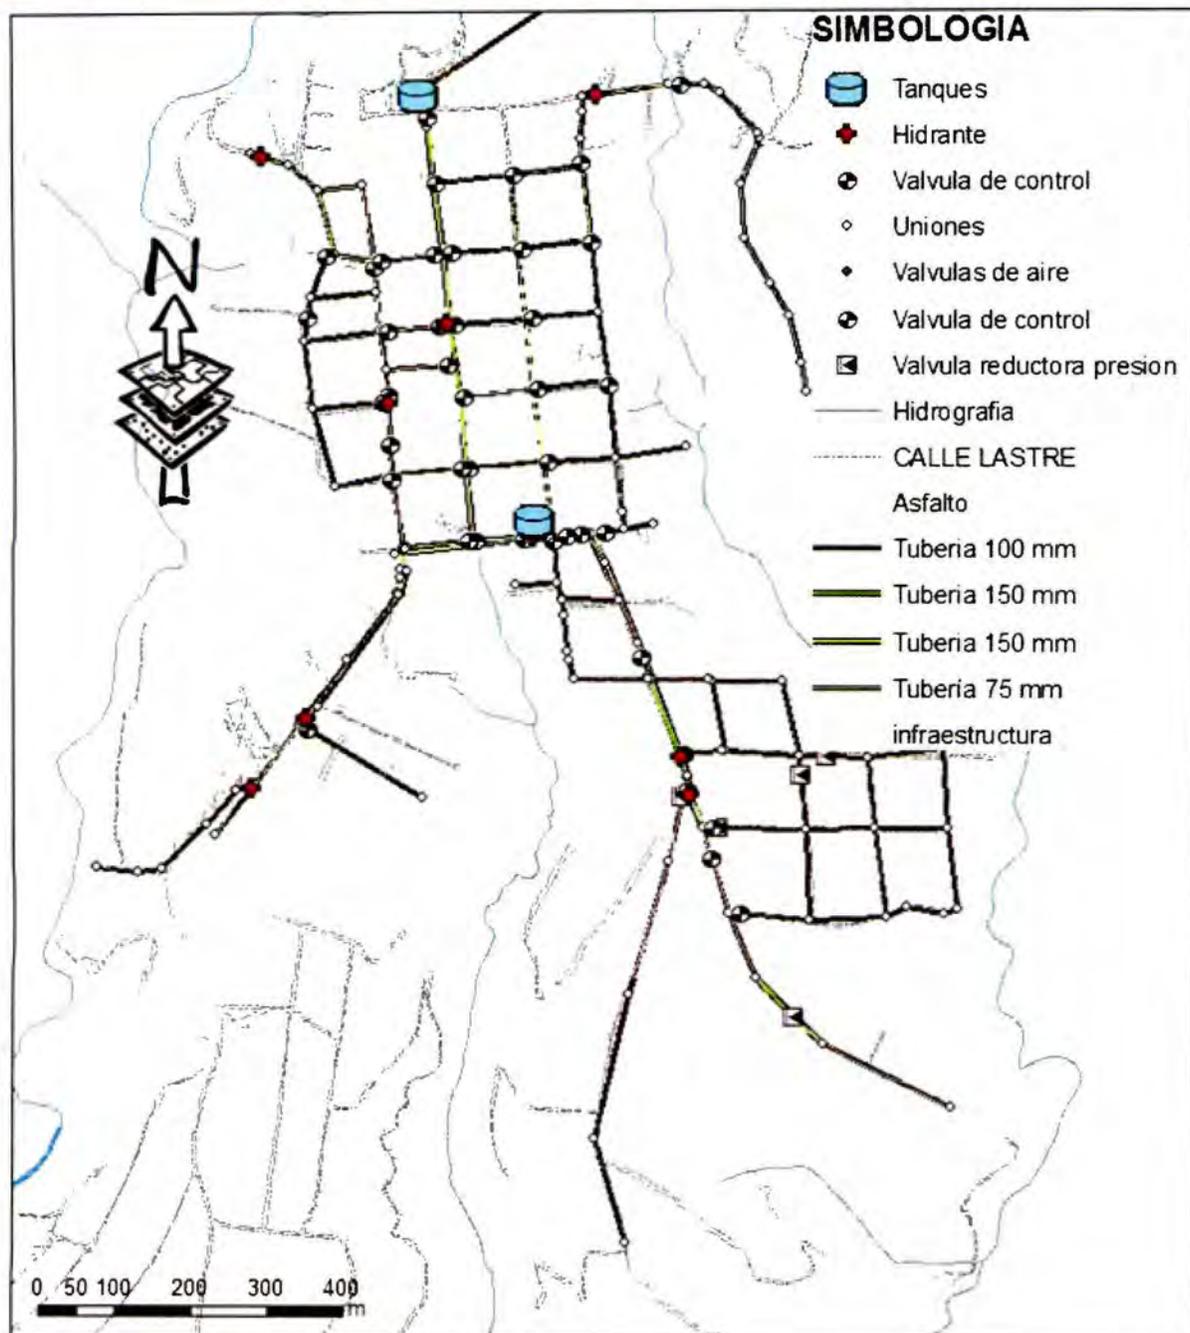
Replanteo Plan Maestro, obras a ejecutar en el acueducto San Jerónimo abajo.
